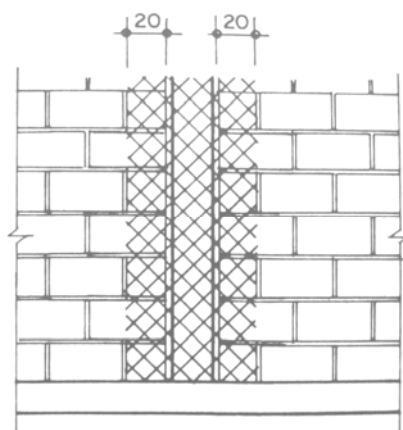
Recuperação de destacamento pilar/parede com tela de estuque
